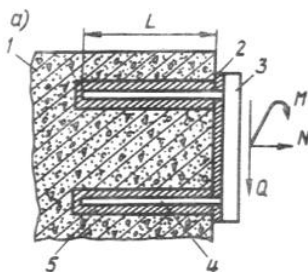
Крепление закладных деталей к бетонным, железобетонным и элементам конструкций:
